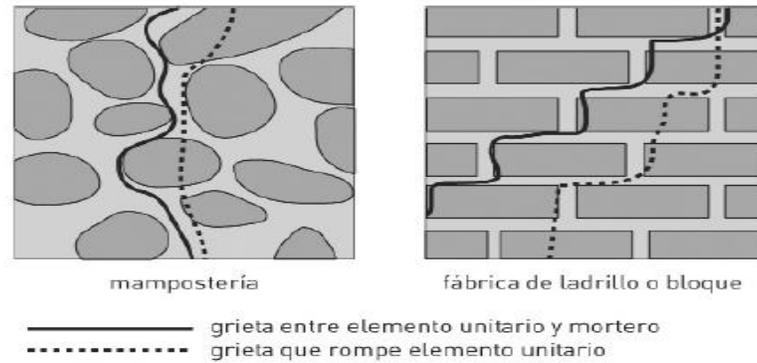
Tipos de grietas en obras de fábrica según línea de rotura.
